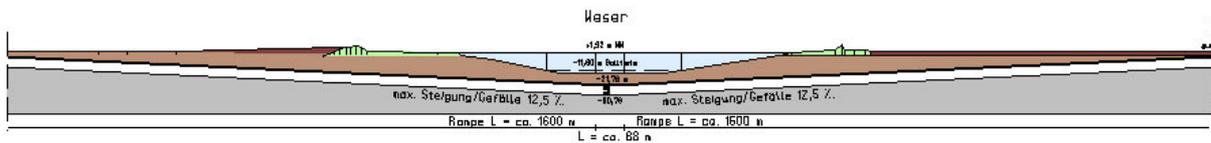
Längsschnitt Gewässerunterquerung, Beispiel Weser
